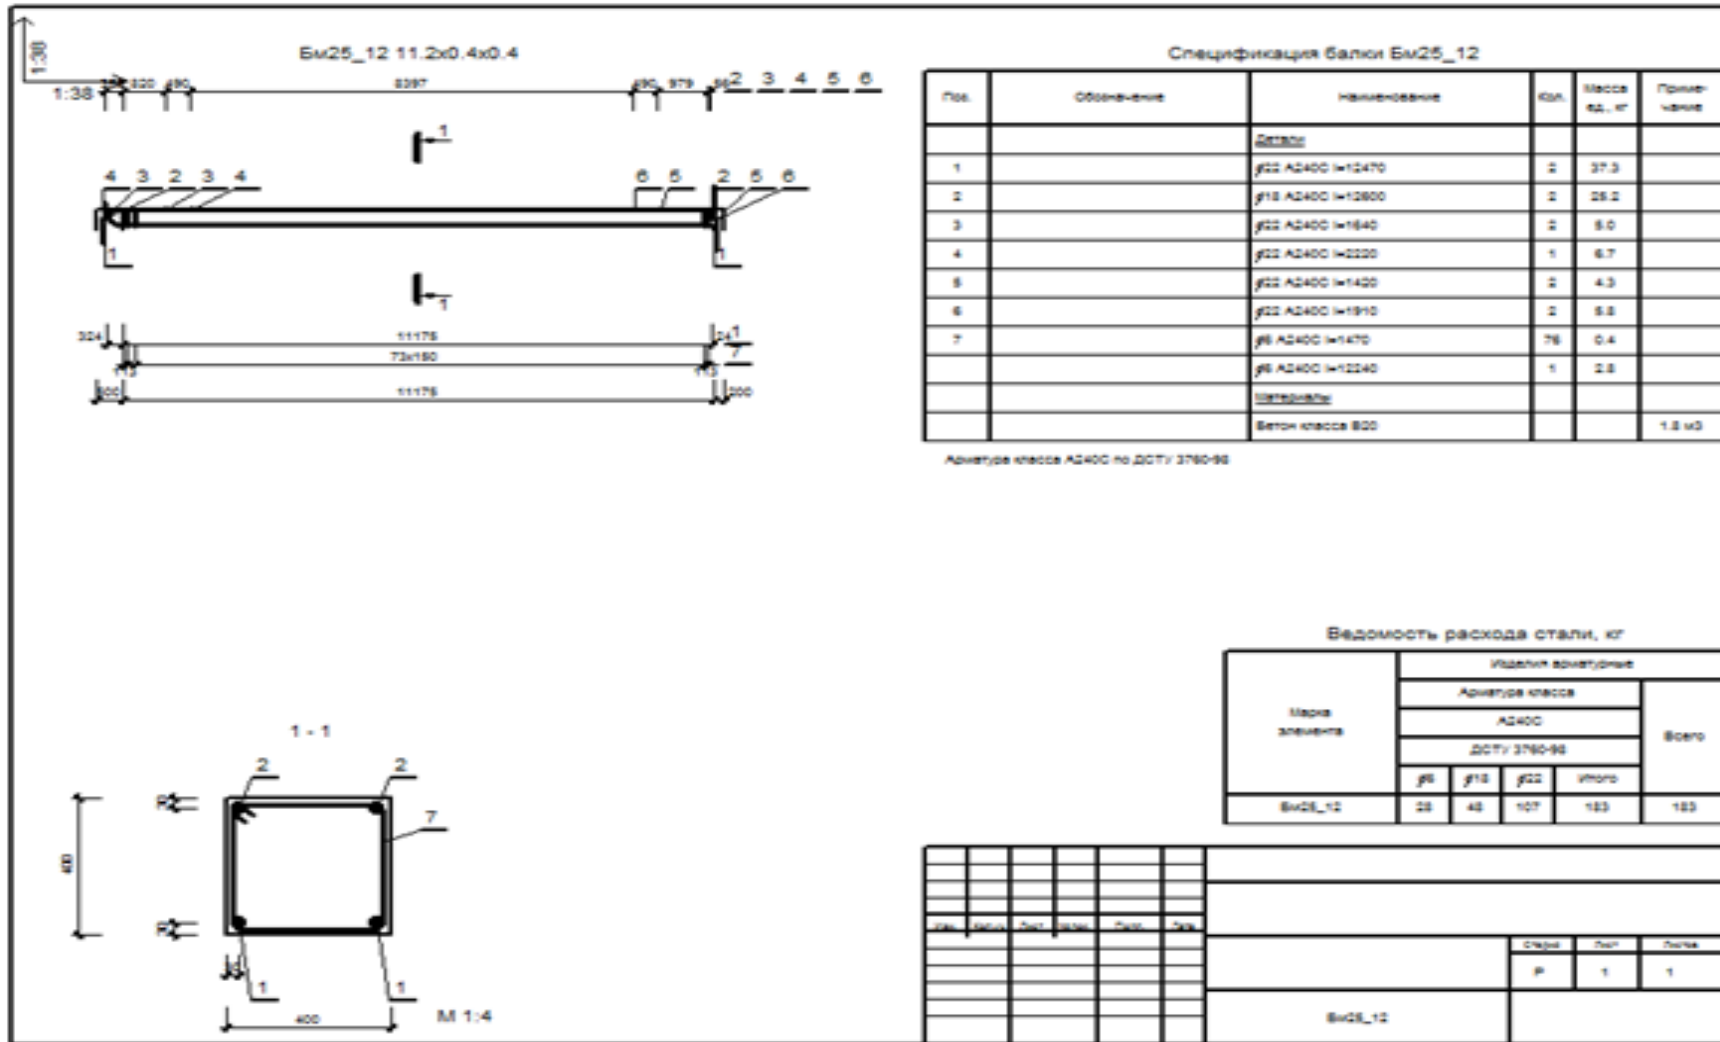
Двадцать п'ятий поверх. Балка B25-12. Креслення робочого проекту
